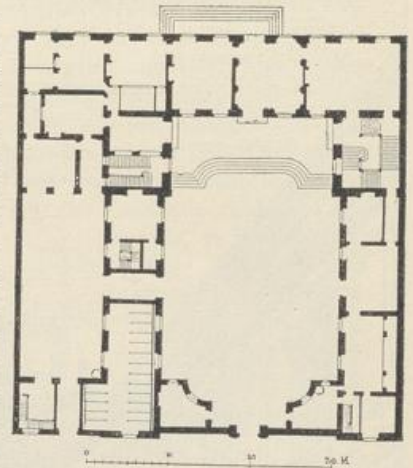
Grundriss des Hotels Chevreuse
